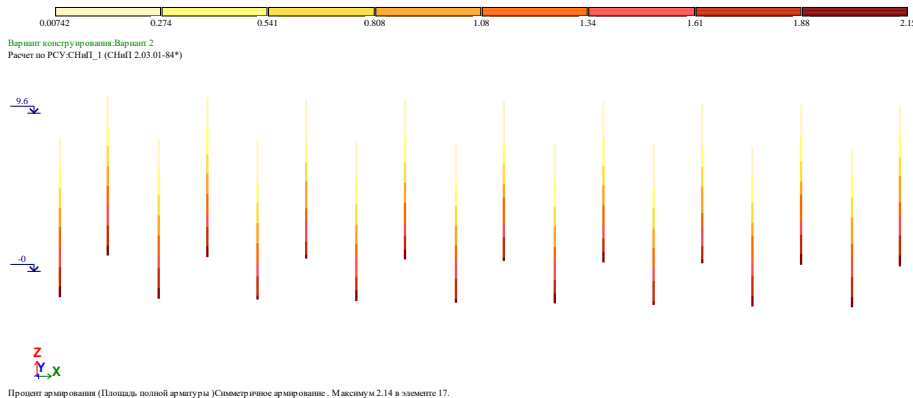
Процент армирования в колоннах (Площадь полной арматуры).
